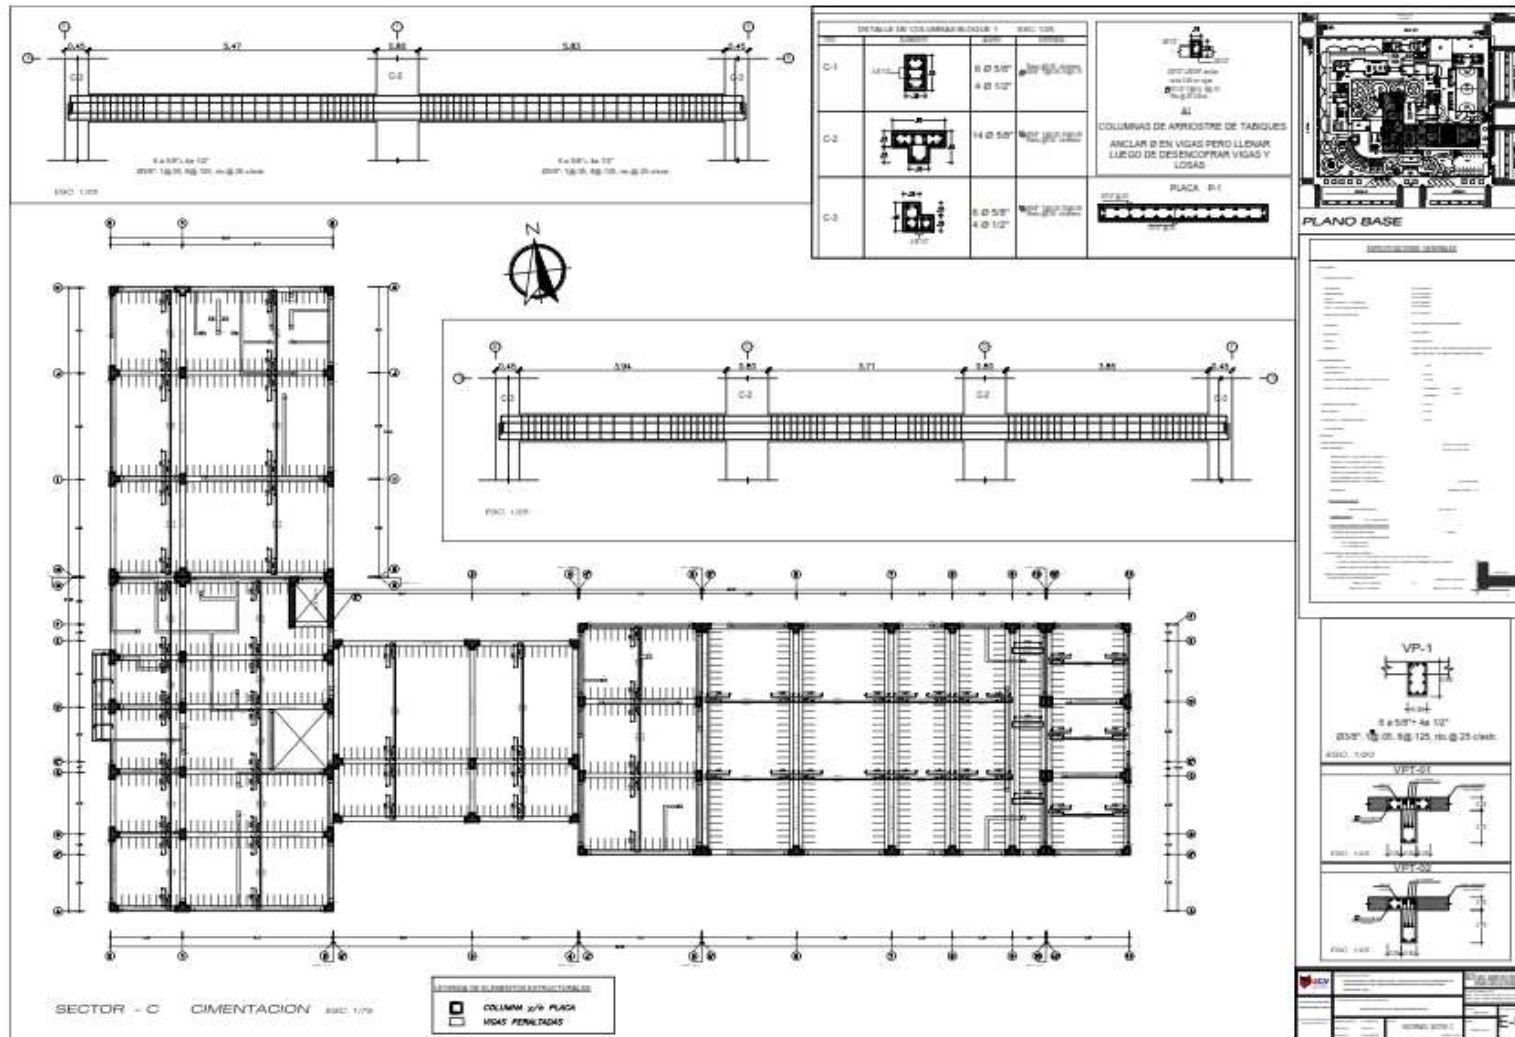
Plano diseño estructural bloque complementarios aligerado – Lamina E-06
